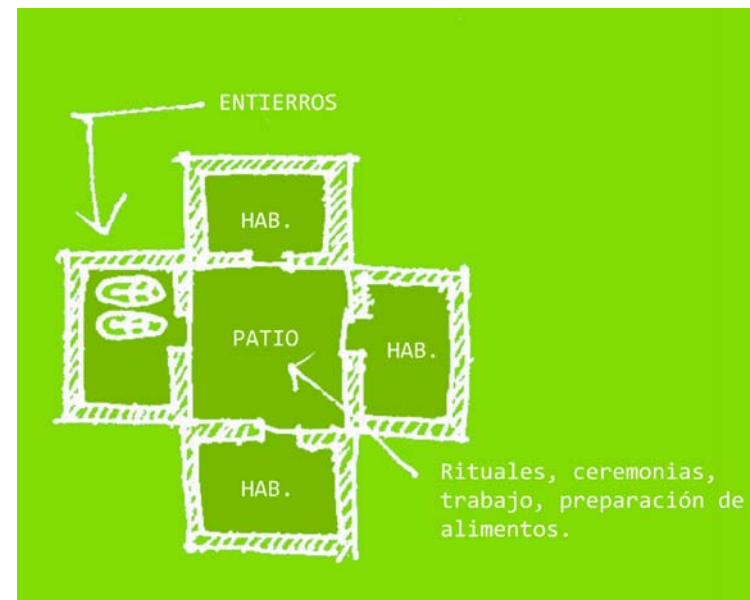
Planta esquemática de casa-habitación tipo A. Winter 1984
